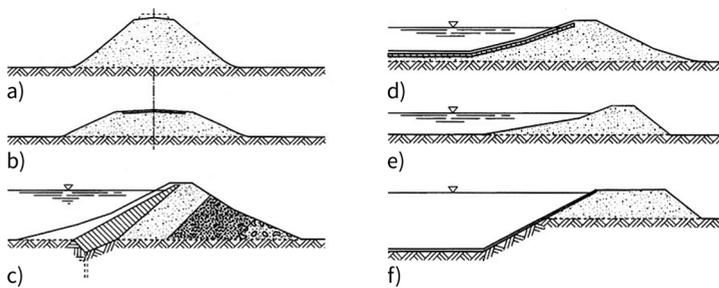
Charakteristische Dammschnitte (nach [50]); a) Eisenbahndamm, b) Straßendamm, c) Staudamm, d) Kanaldamm, e) Deich, f) Deponiedamm
